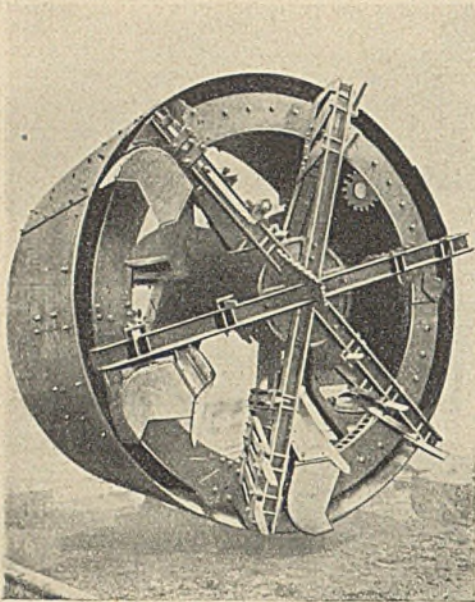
Tunnelschild der Londoner Untergrundbahnen.
